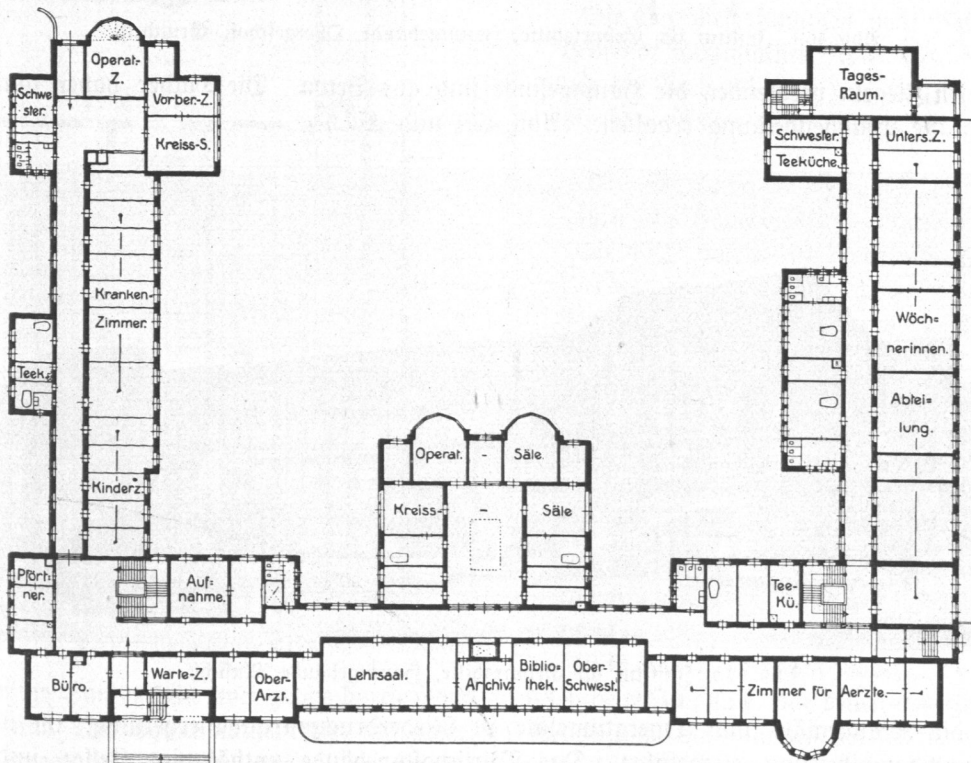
Institut für Geburtshilfe, Hauptgebäude, Erdgeschoß, Grundriß.
